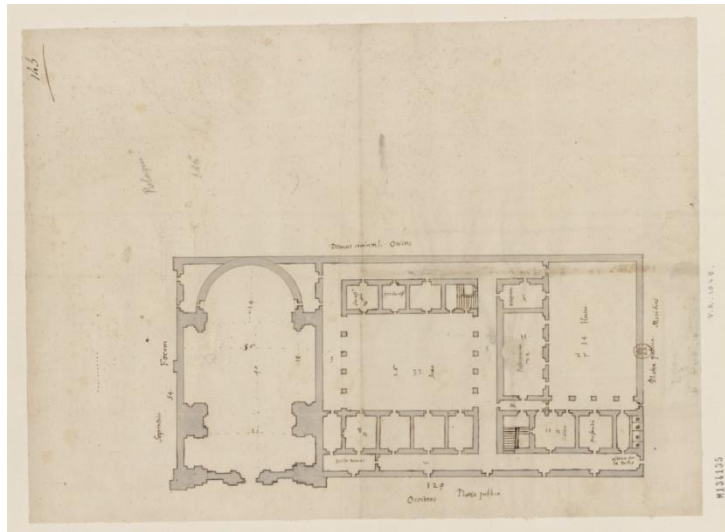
Plan N. R. 1048, Projekt der Kirche und des Klosters in der Wiślnastraße, Braccio, 1593.
